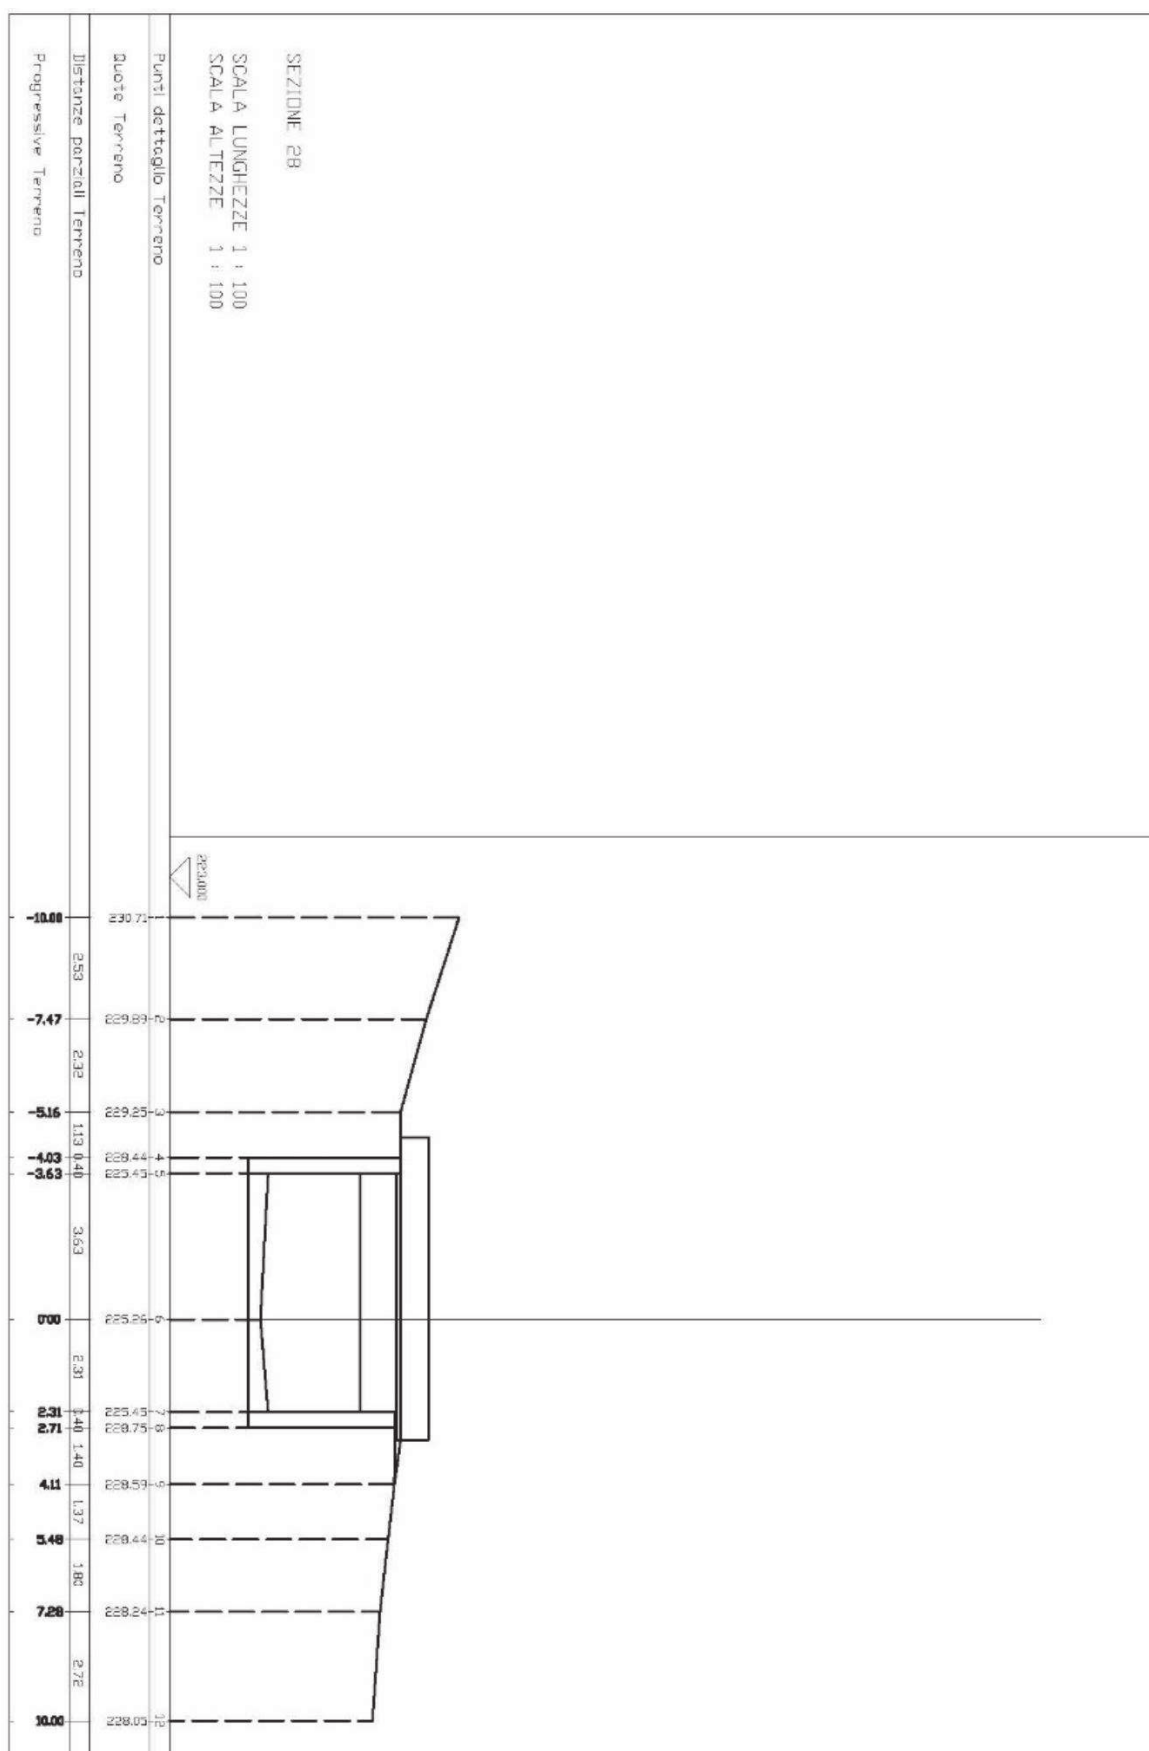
Sezione trasversale di monte dell'attraversamento stradale.
